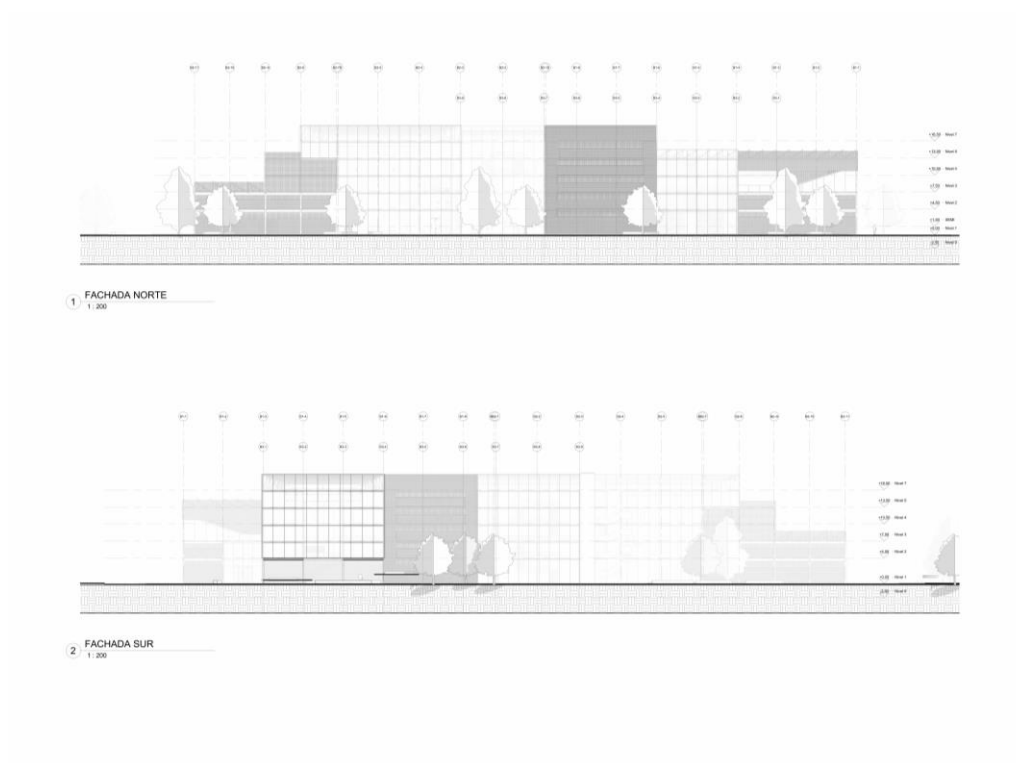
Fachadas Norte - Sur. Fuente: Propia.
